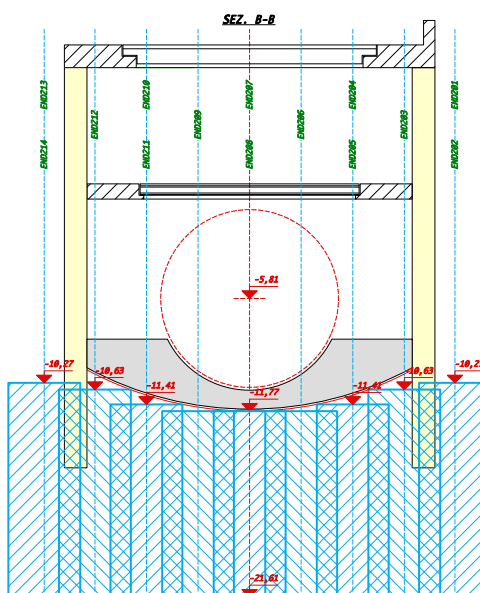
Sezione tipo B dei trattamenti ad Eixample Nord.
